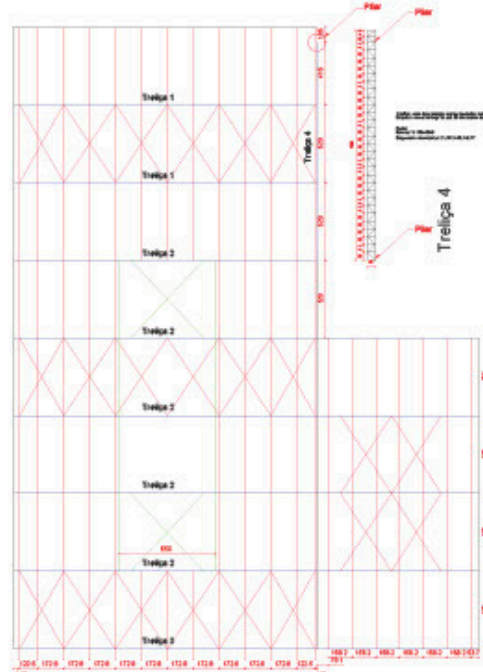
Esquema das estruturas metálicas das coberturas 2 e 3 em planta. Cotas em centímetros.
